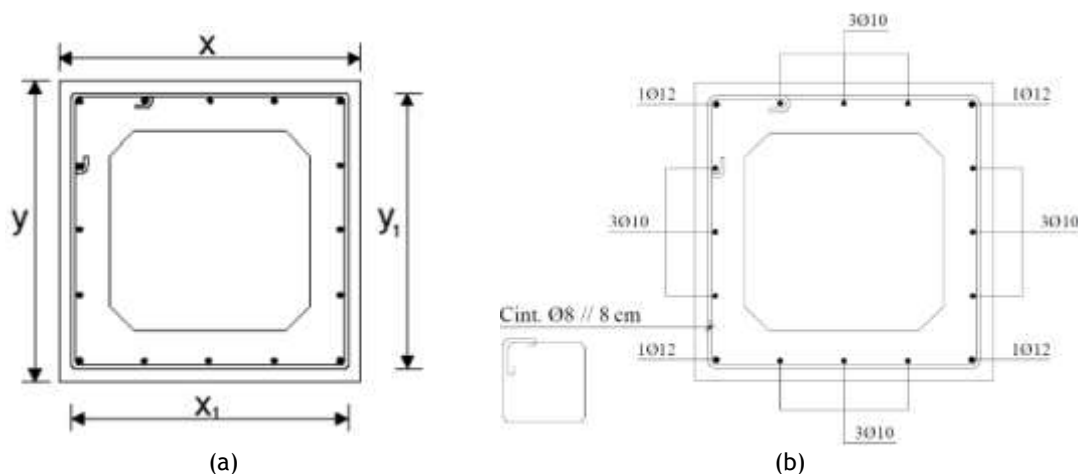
(a) Corte transversal da viga A2 com referência ao posicionamento da armadura; (b) pormenorização da secção transversal da viga A2 [17]
